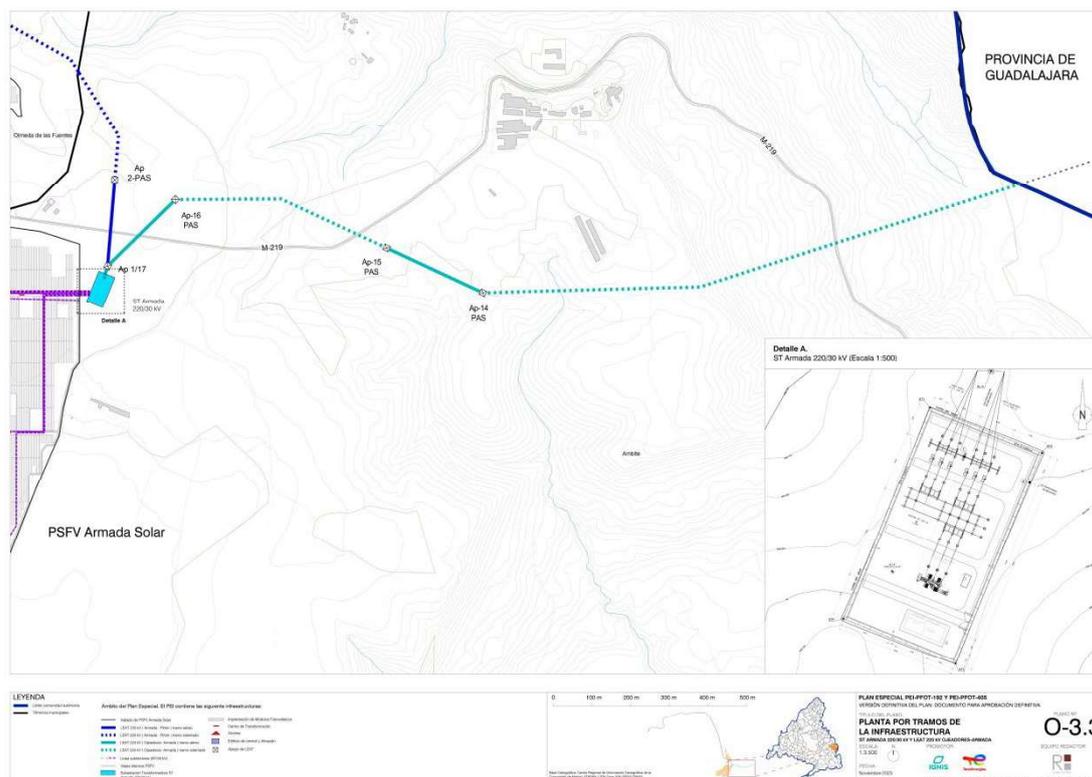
Detalle de implantación de la ST Armada. Fuente: RH estudio.
